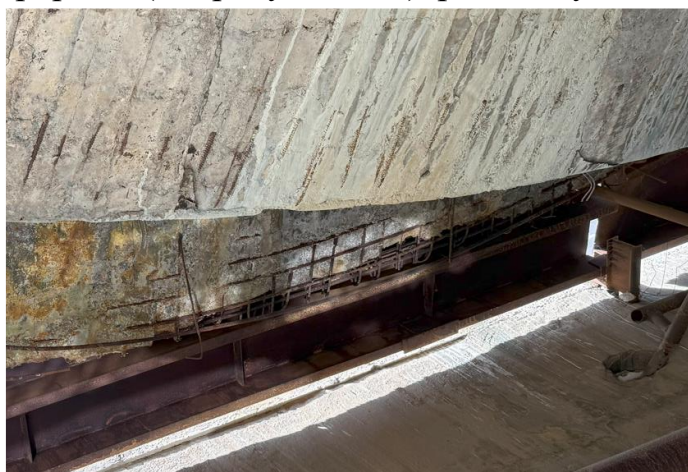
Глубокое разрушение бетона ходовой площадки
